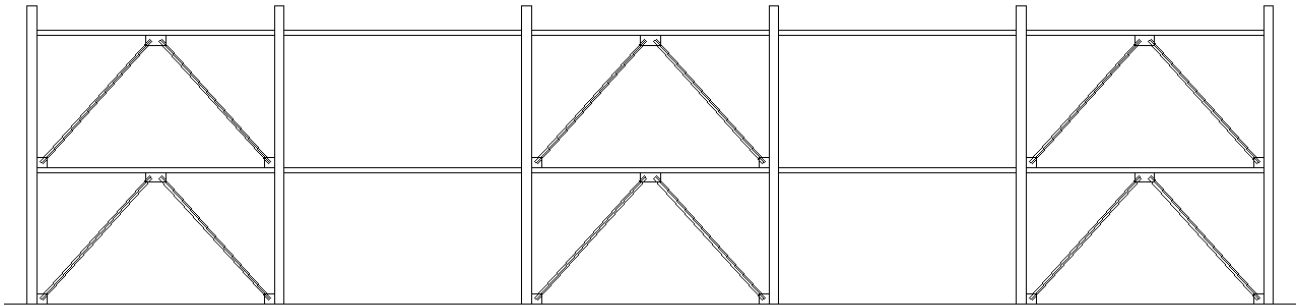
Estructura longitudinal rigidizada con contravéntes rígidos en "V" invertida en dos niveles en marcos discontinuos
